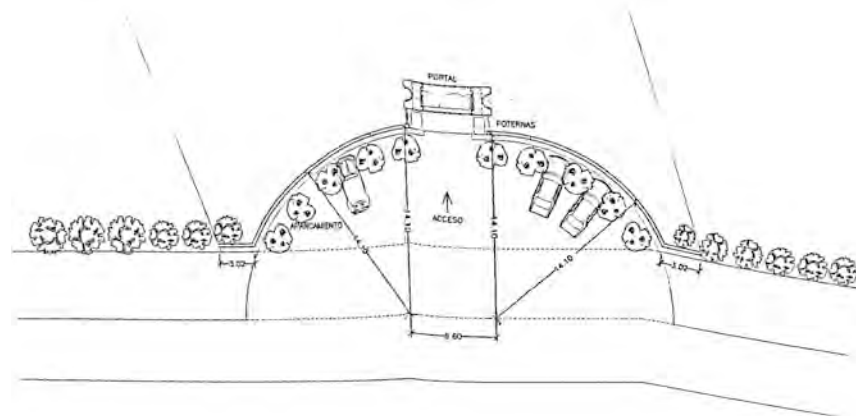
Modificación de la planimetría del proyecto de acceso al yacimiento. (Cuadrado, 1998)
